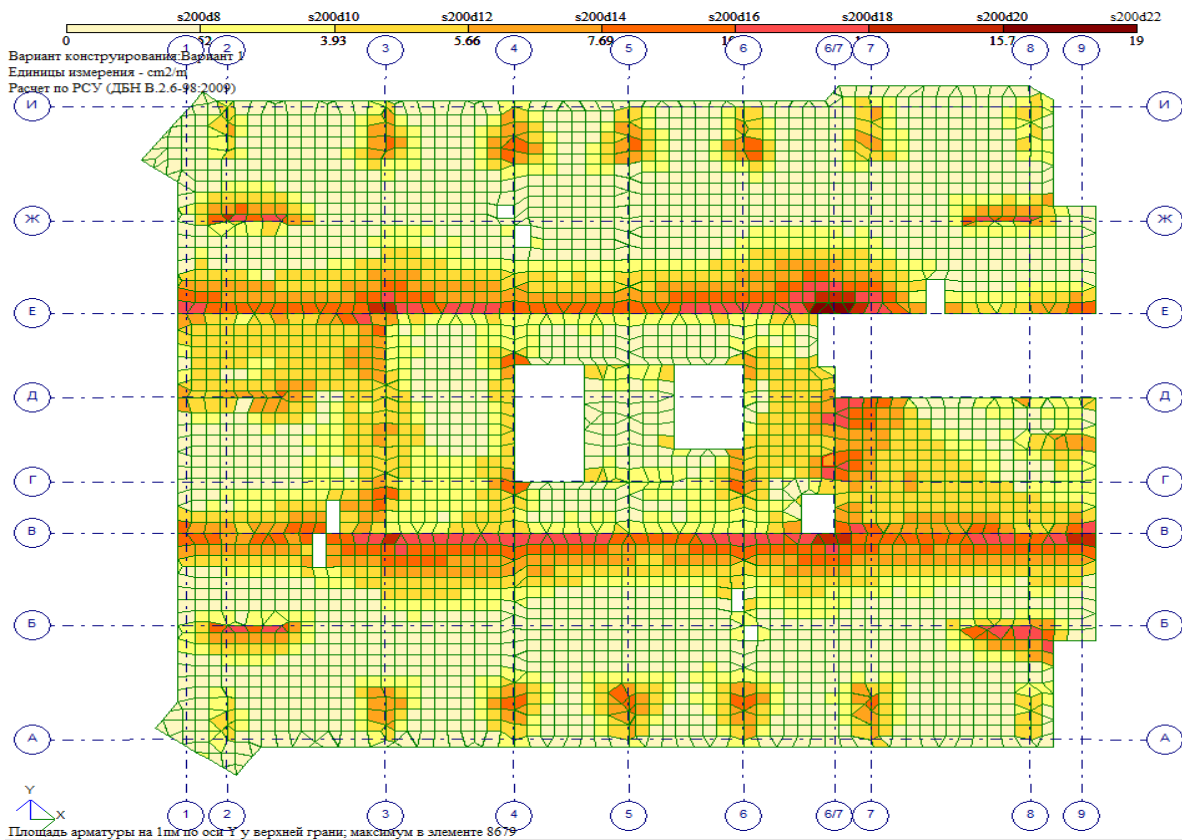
Перекрыття на відмітці 0.000 м. Верхня арматура по Y
